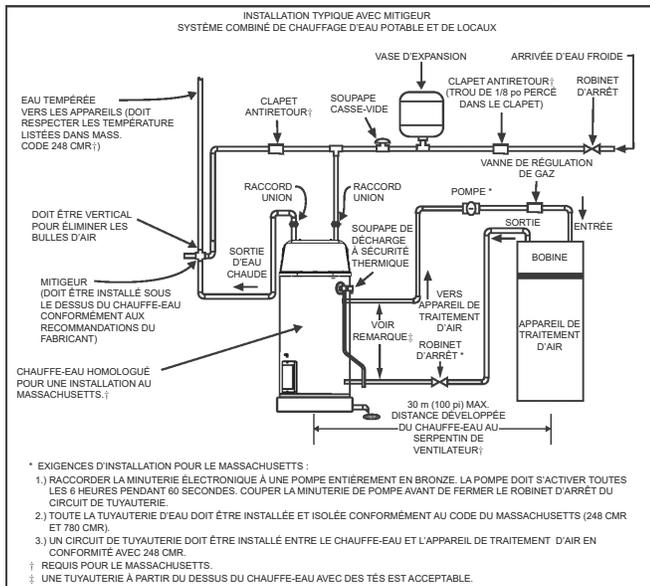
Installation typique avec mitigeur et chauffage de locaux
